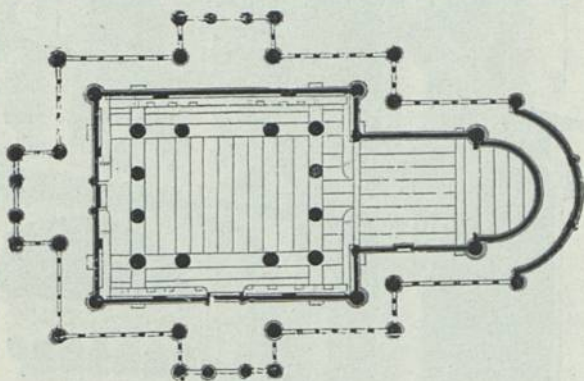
Grundriss der Kirche zu Borgund
